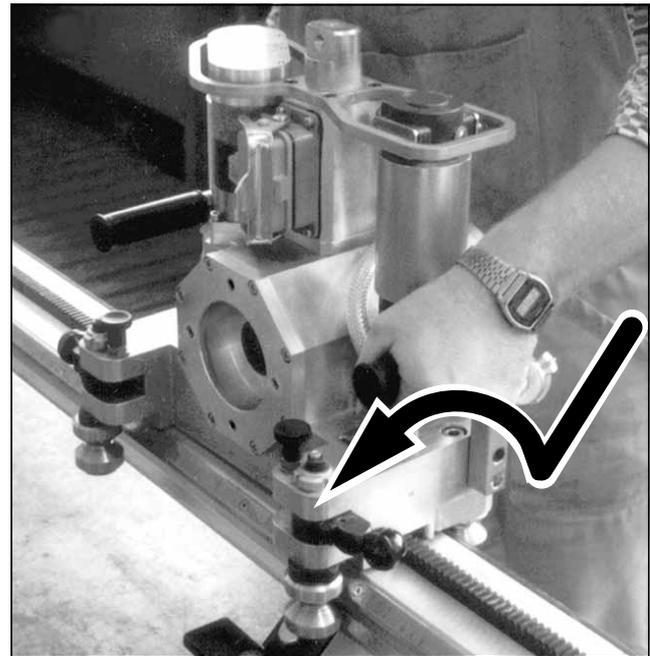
Установка корпуса пилы на направляющий рельс
